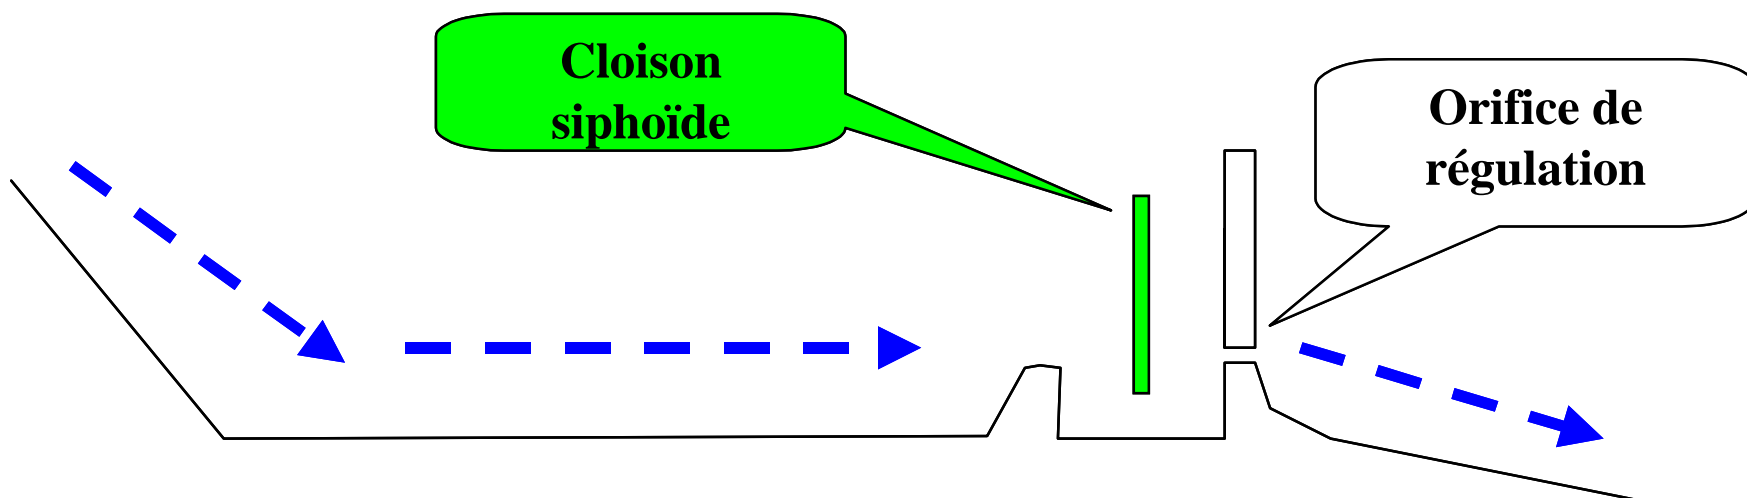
Schéma de principe du traitement simple des eaux pluviales
